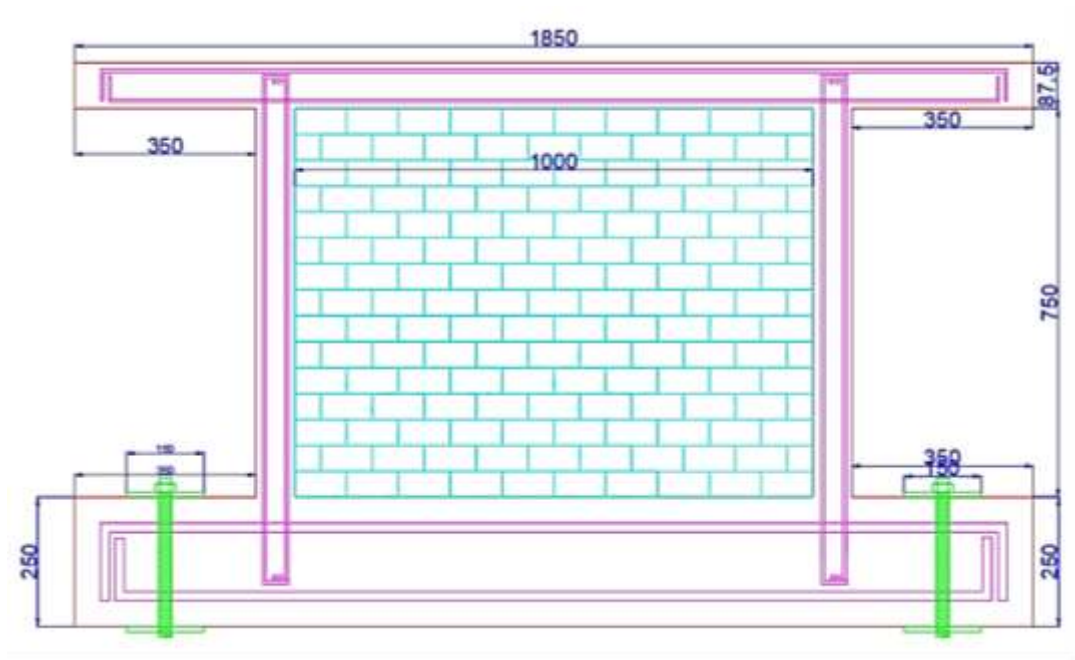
Pórtico de hormigón de 100cm x 75cm con relleno.
